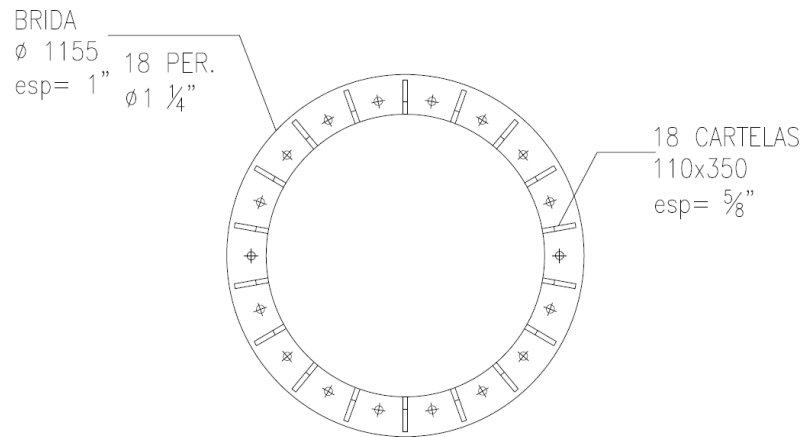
Vista en planta de una brida. Tomado de: Elaboración propia.
